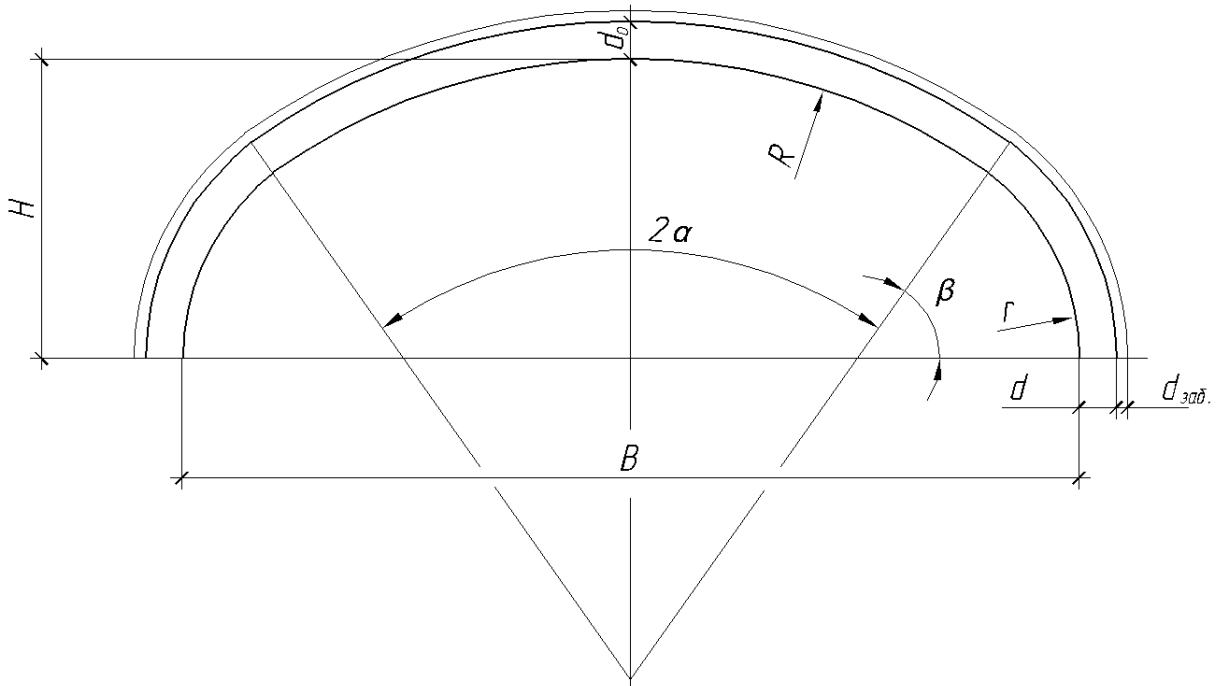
Схема до розрахунку навантаження на монолітне бетонне кріплення
